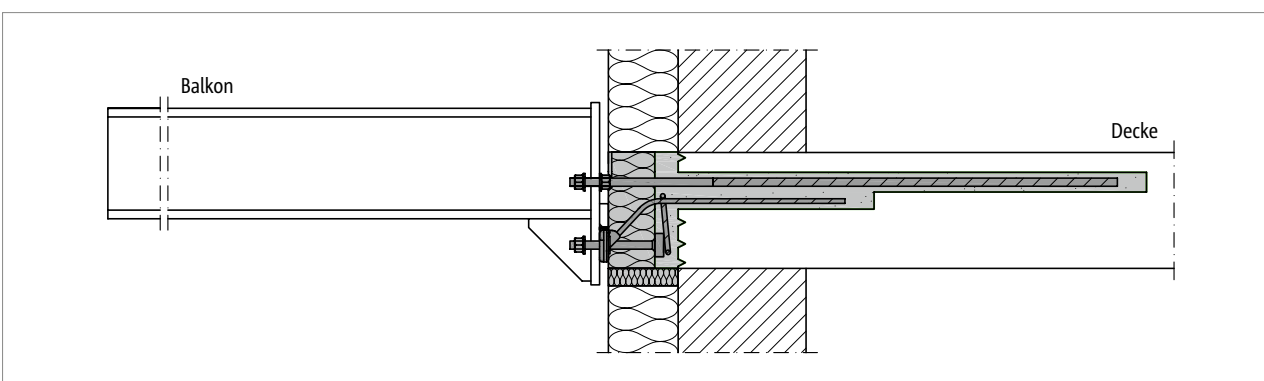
Schöck Isokorb® RT Typ SK: Barrierefreier Übergang durch Höhenversatz
